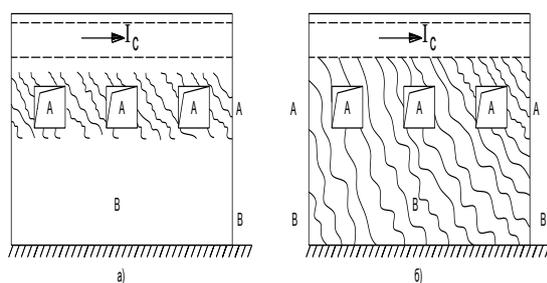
Расчетная схема фрагмента здания с проемами *аи б* – ожидаемая и фактическая схема разрушения
